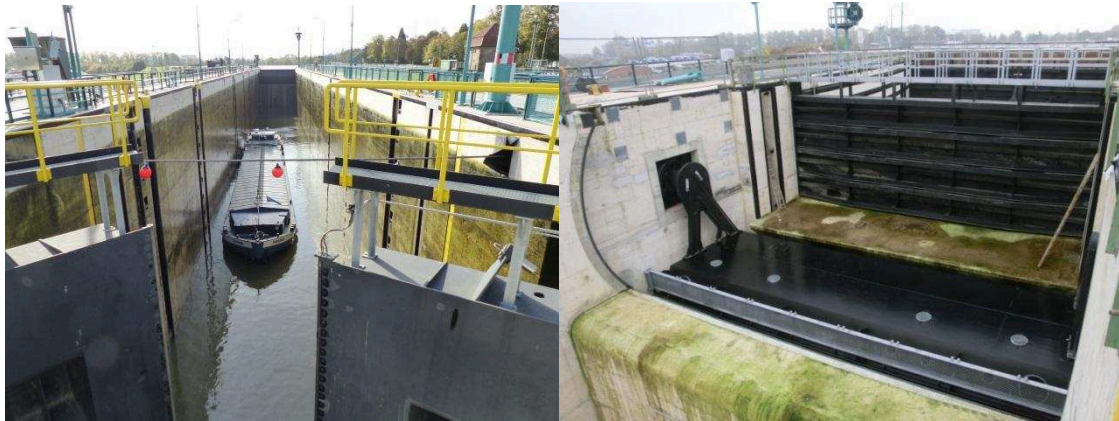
Drehsegmentobertor (links) und Stemmtor (rechts) jeweils in der geöffneten Stellung.
